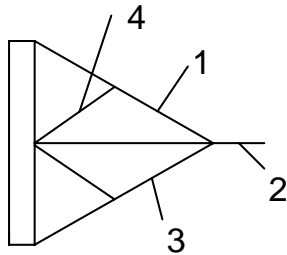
Схема усиления металлоконструкции дополнительными раскосами
